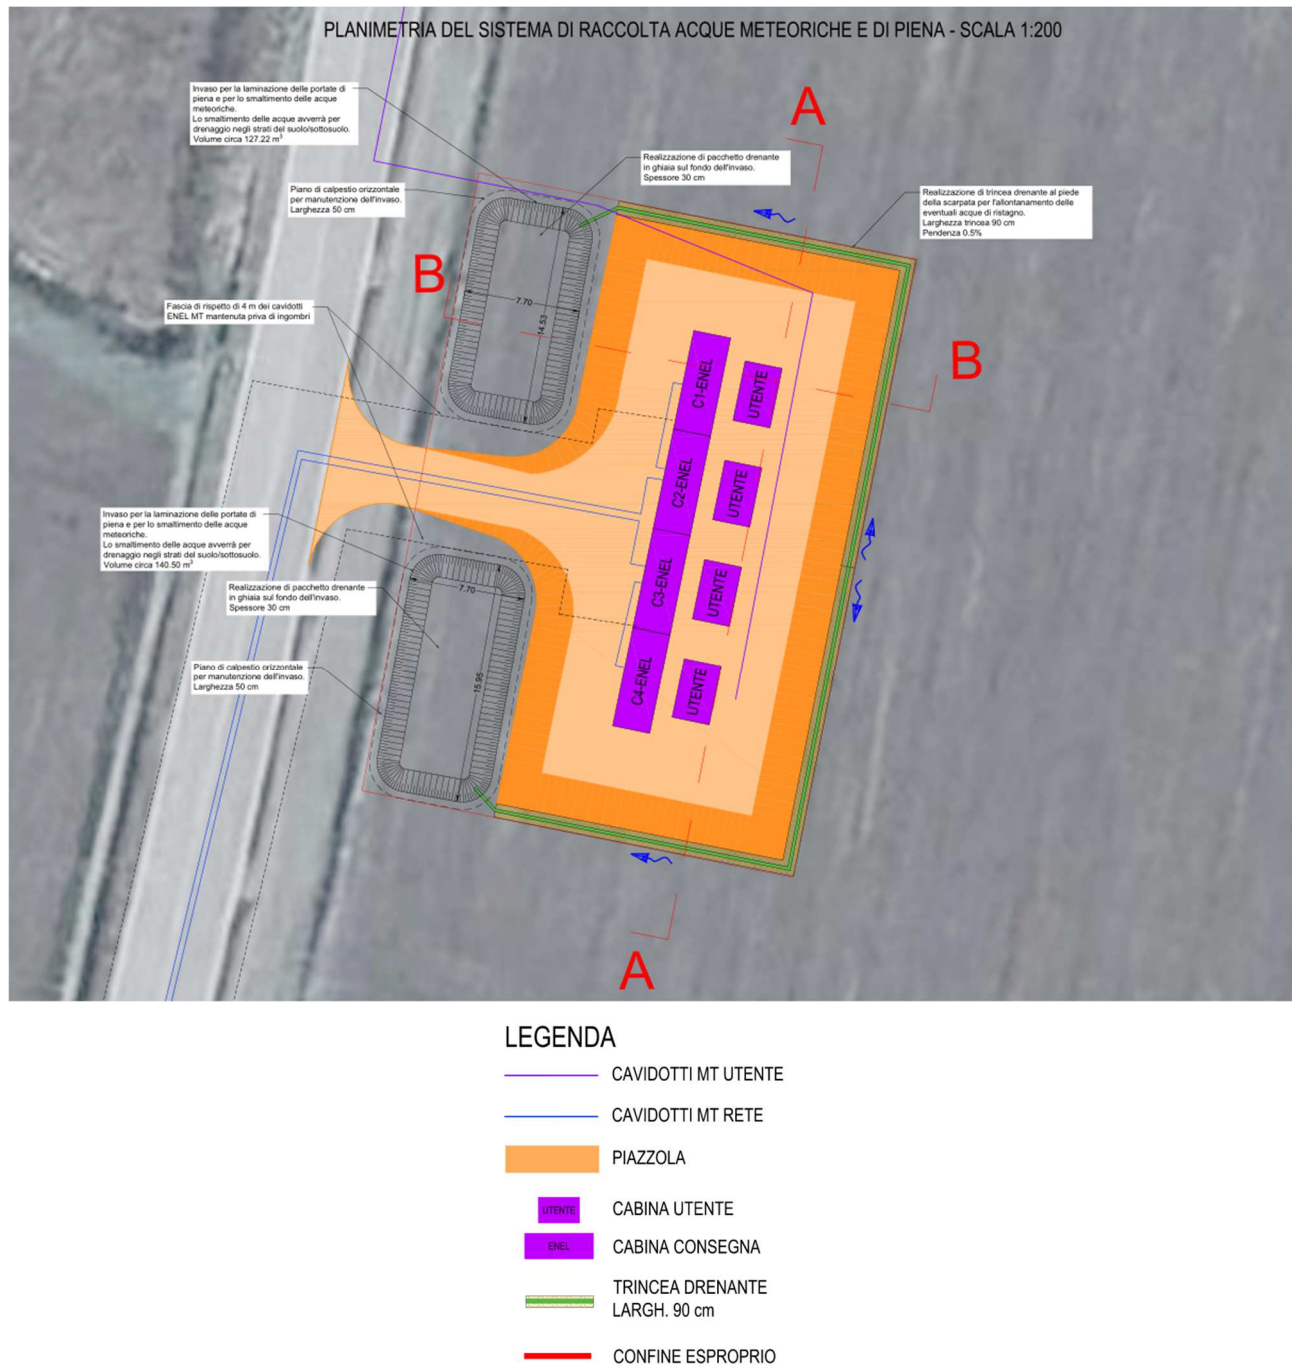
Planimetria della sistemazione idraulica delle cabine di consegna.
